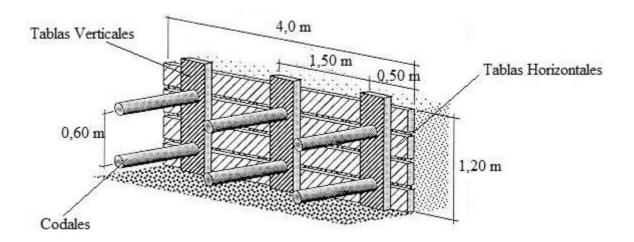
Detalle constructivo de entibación para excavaciones provisionales.
